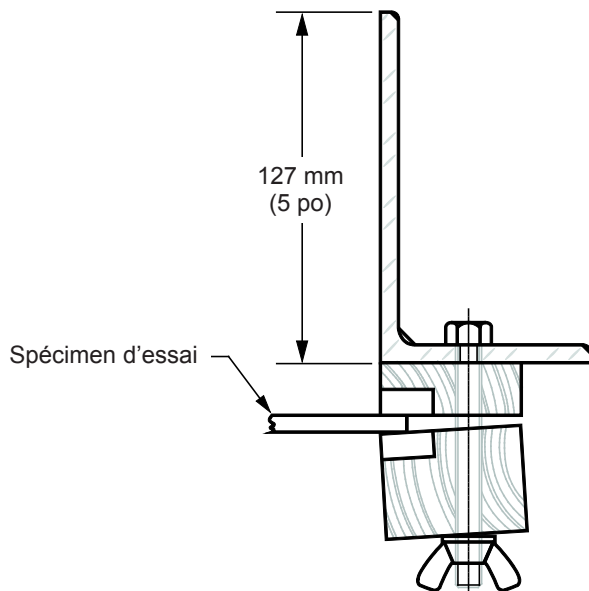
Détail de la coupe A-A — Spécimen d'essai incorrectement fixé (>3 mm [1/8 po])
